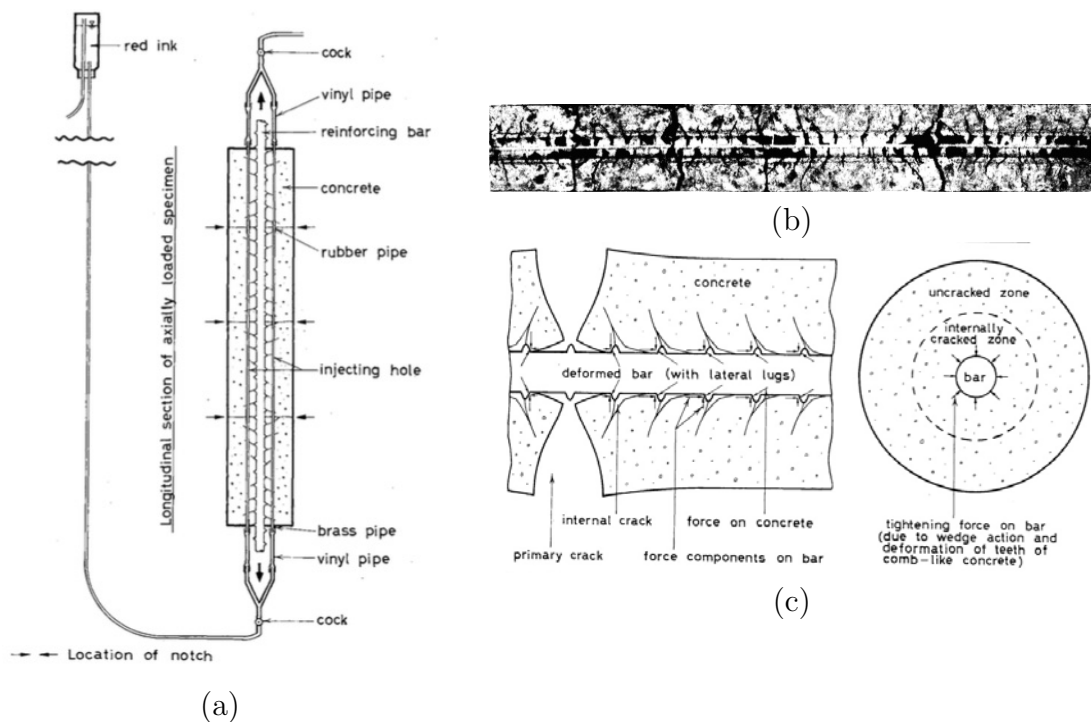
Caractérisation de la fissuration à l'interface acier-béton : (a) dispositif expérimental avec injection d'encre, (b) faciès de fissuration interne, (c) transcription schématique des dégradations à l'interface [Goto, 1971].
